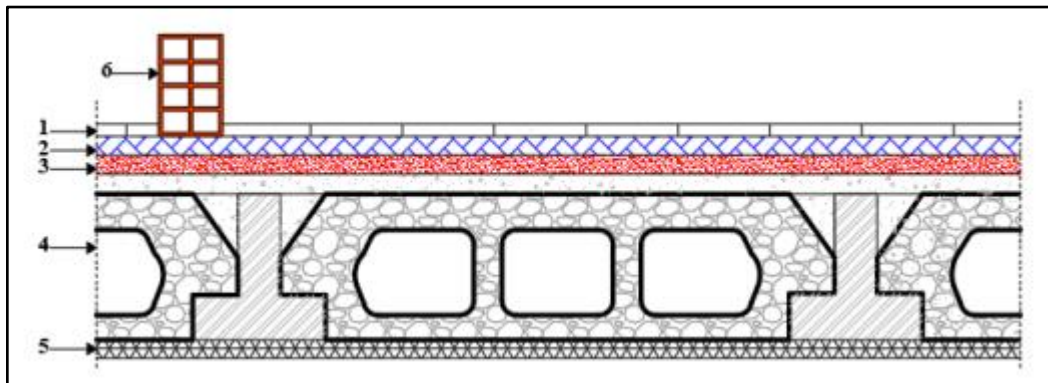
Coupe verticale d'un plancher étage courant en corps creux
